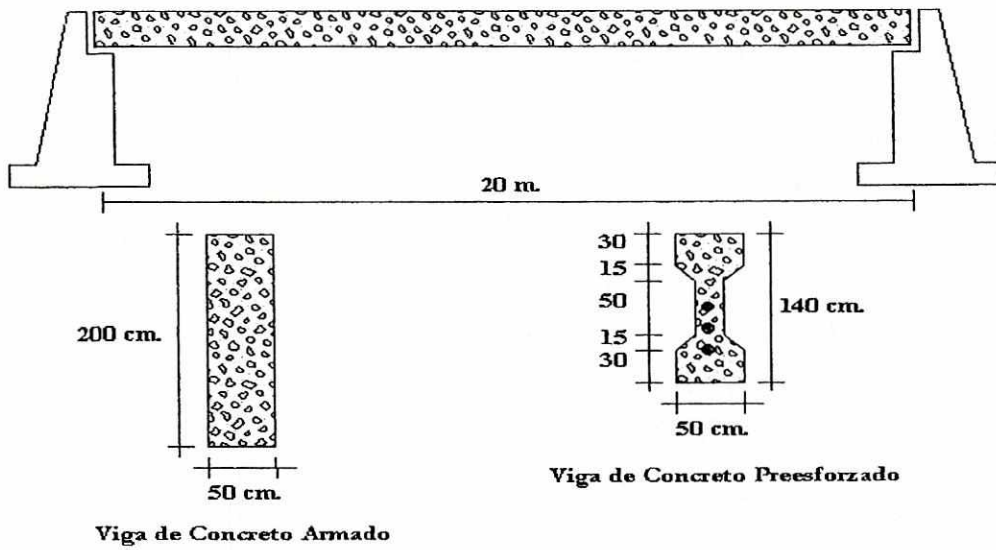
Viga de concreto reforzado y viga de concreto preesforzado
